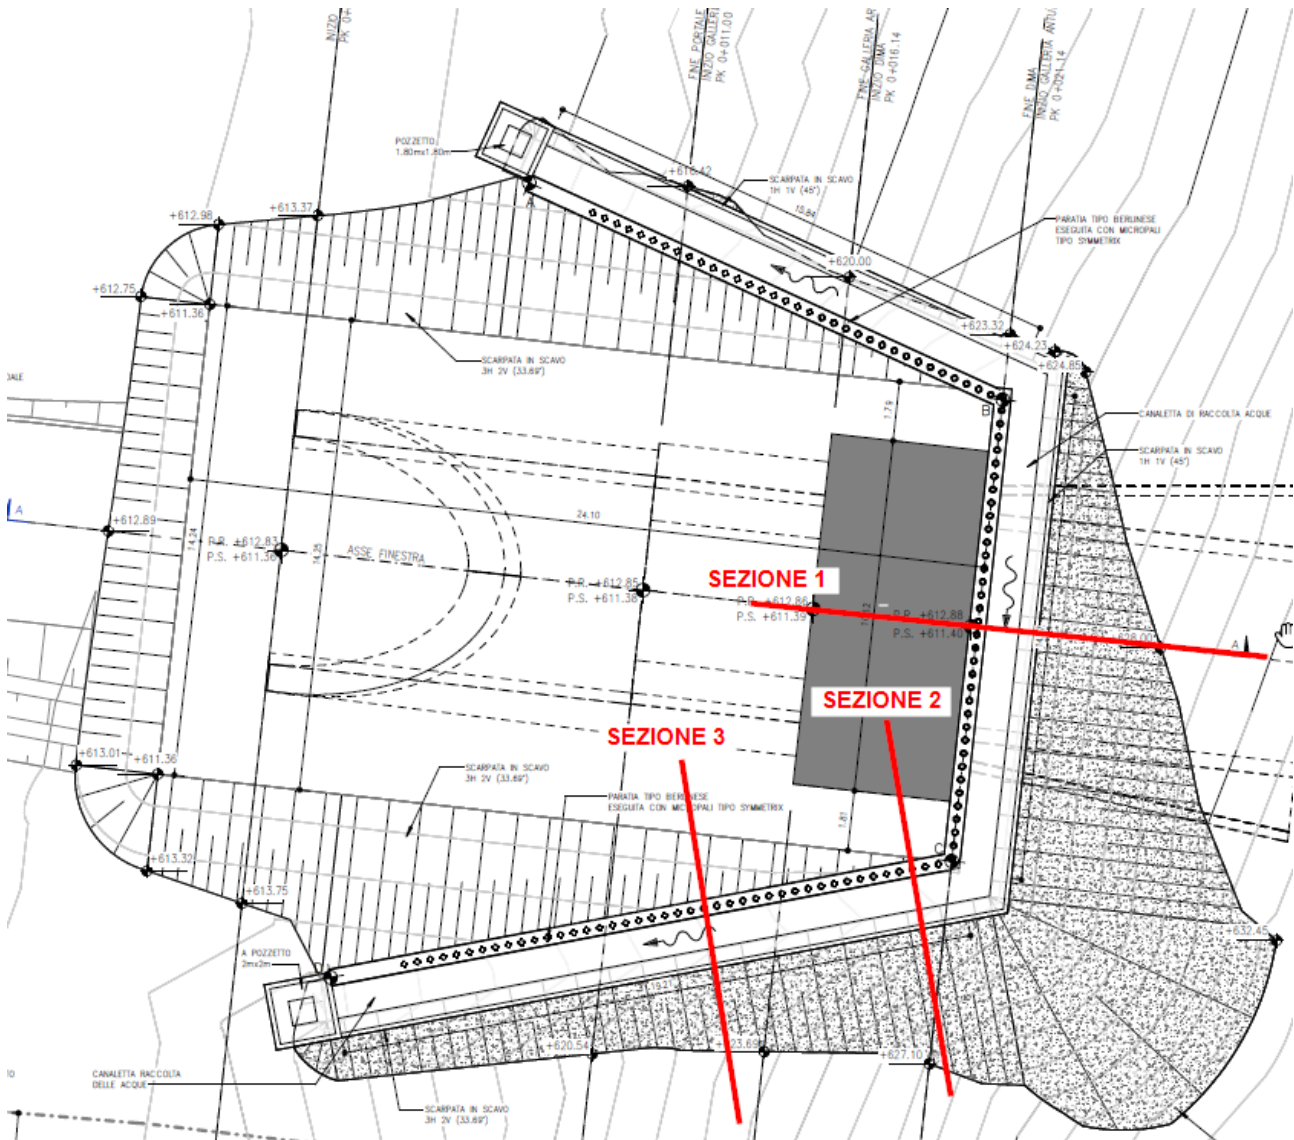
Planimetria con indicazione delle sezioni di calcolo
